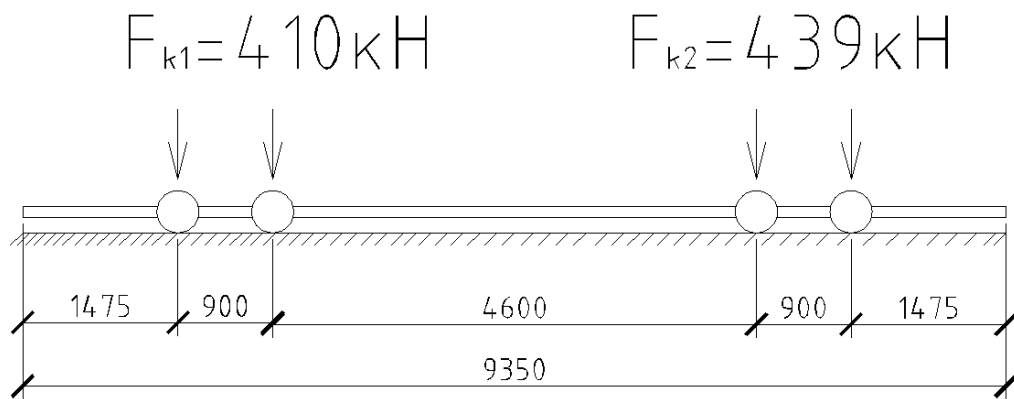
Габариты мостового крана и вертикальные усилия от него
